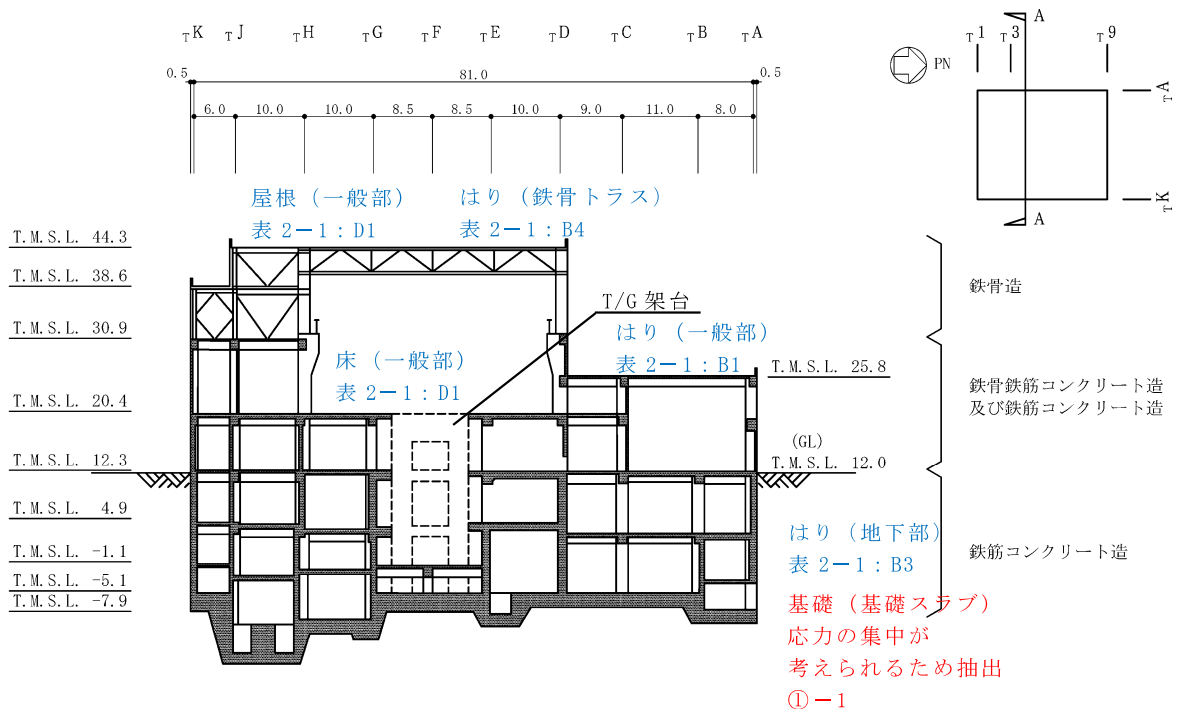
タービン建屋の概略断面図 (EW 方向) (2/2) (単位:m)
